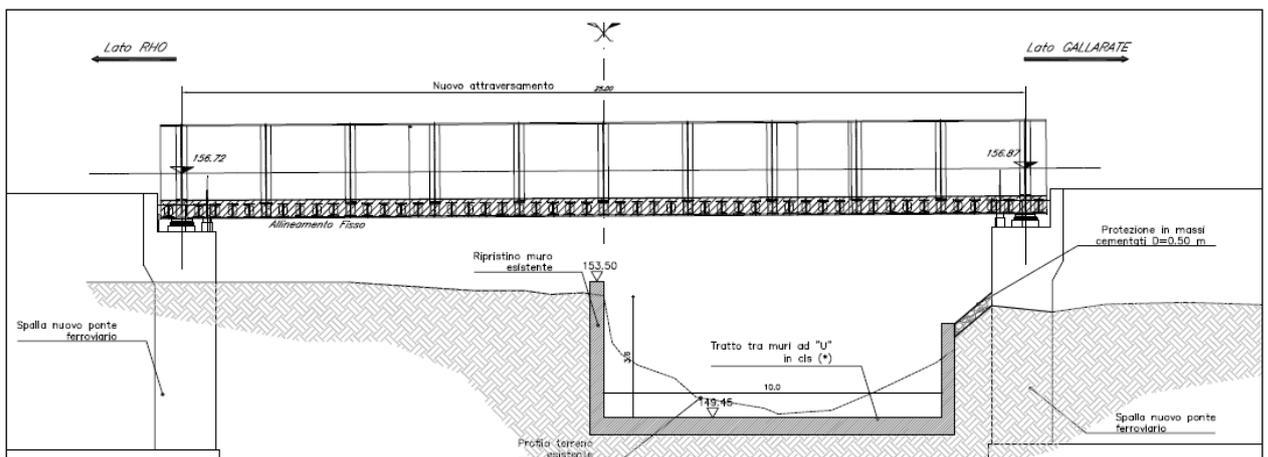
Sistemazione idraulica dell'alveo – primo tratto
